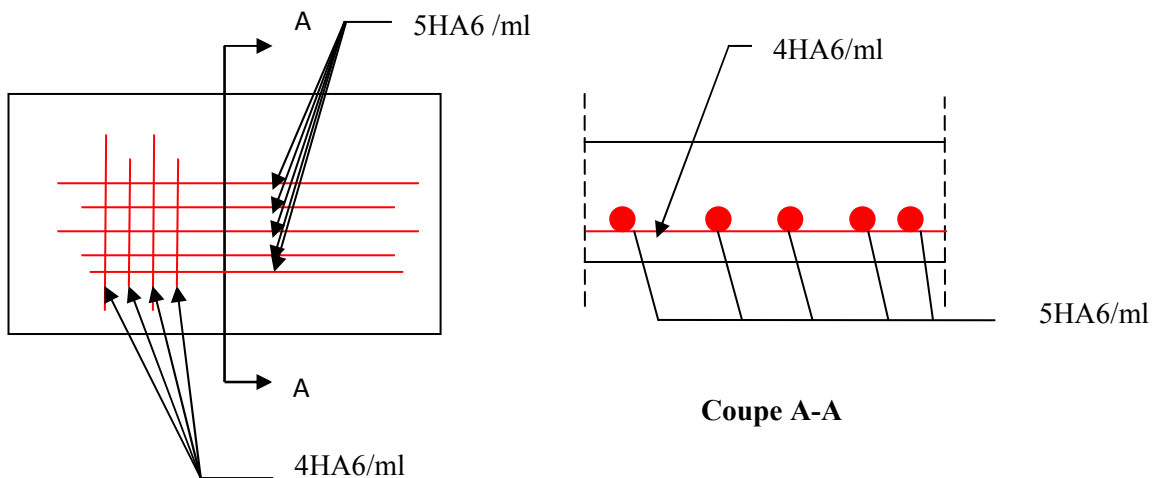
Schéma de ferrailage de la dalle sur deux appuis.
